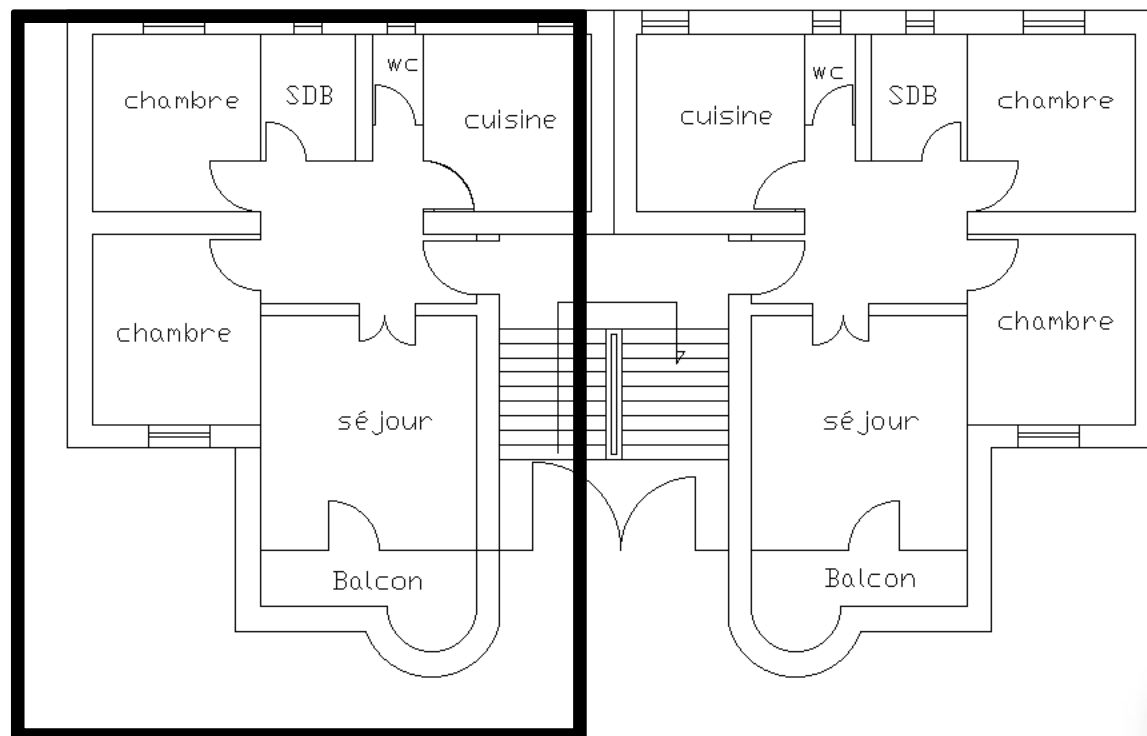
17 : plan RDC initial de cellule01 source auteur.
